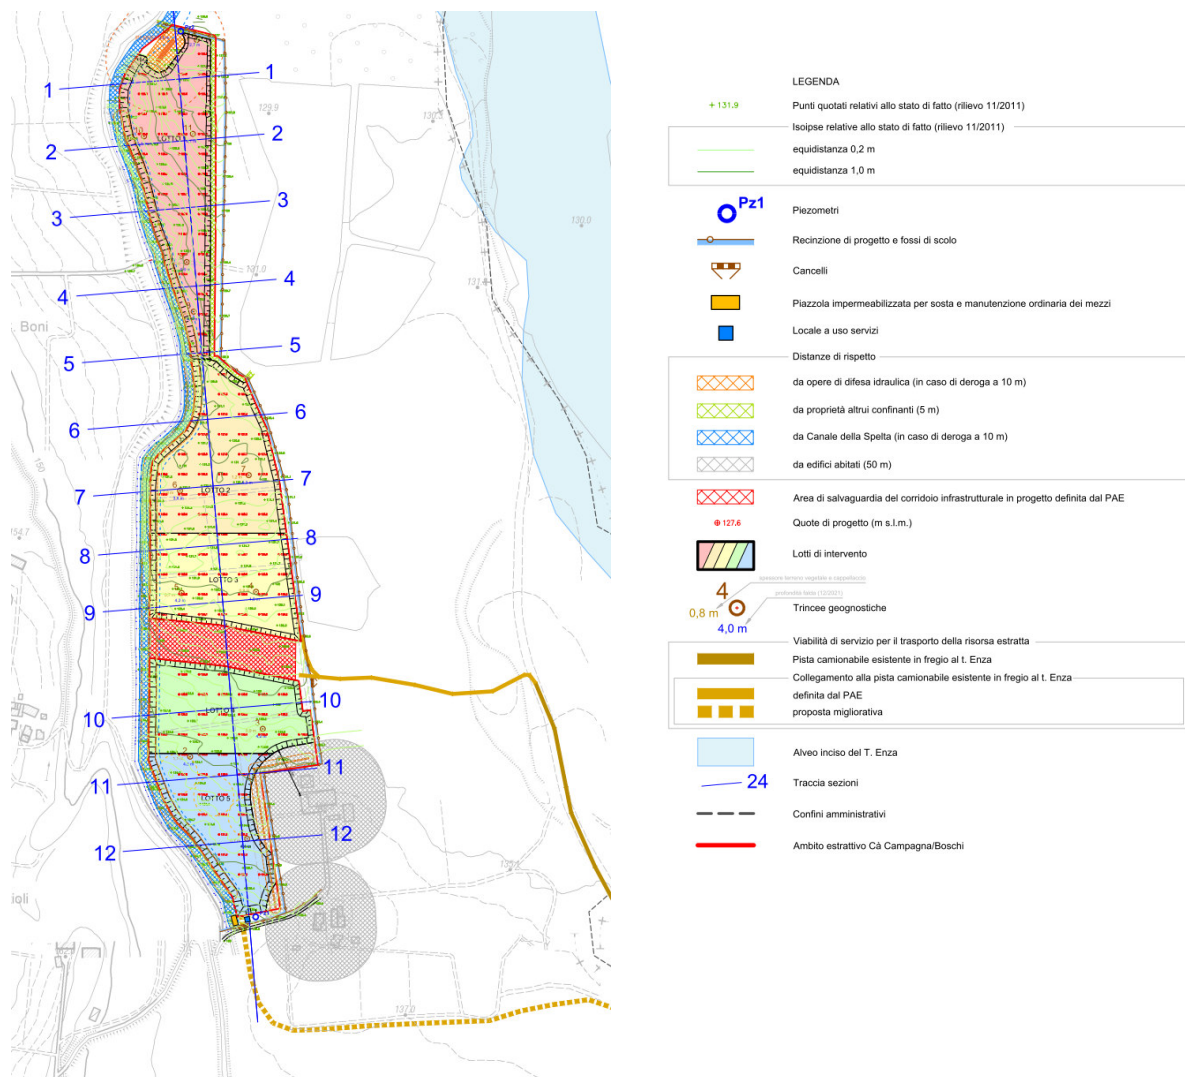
Estratto della Tav. P01 'Progetto di coltivazione' del Piano di coltivazione
